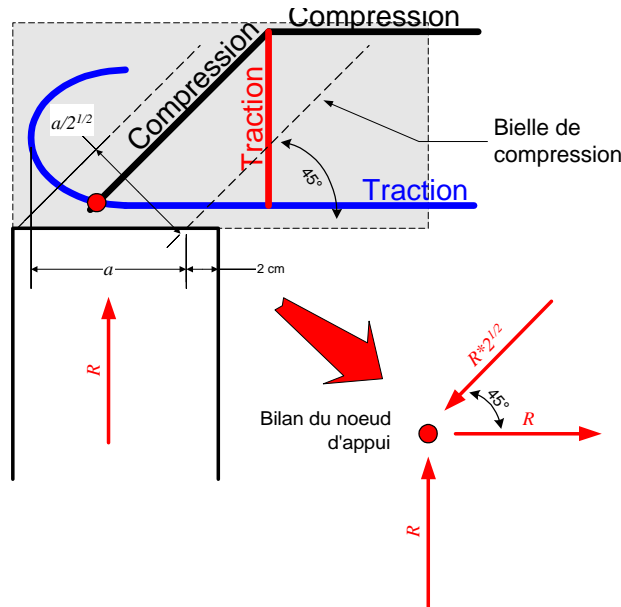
Bilan du noeud d'appui d'un poutre BA
